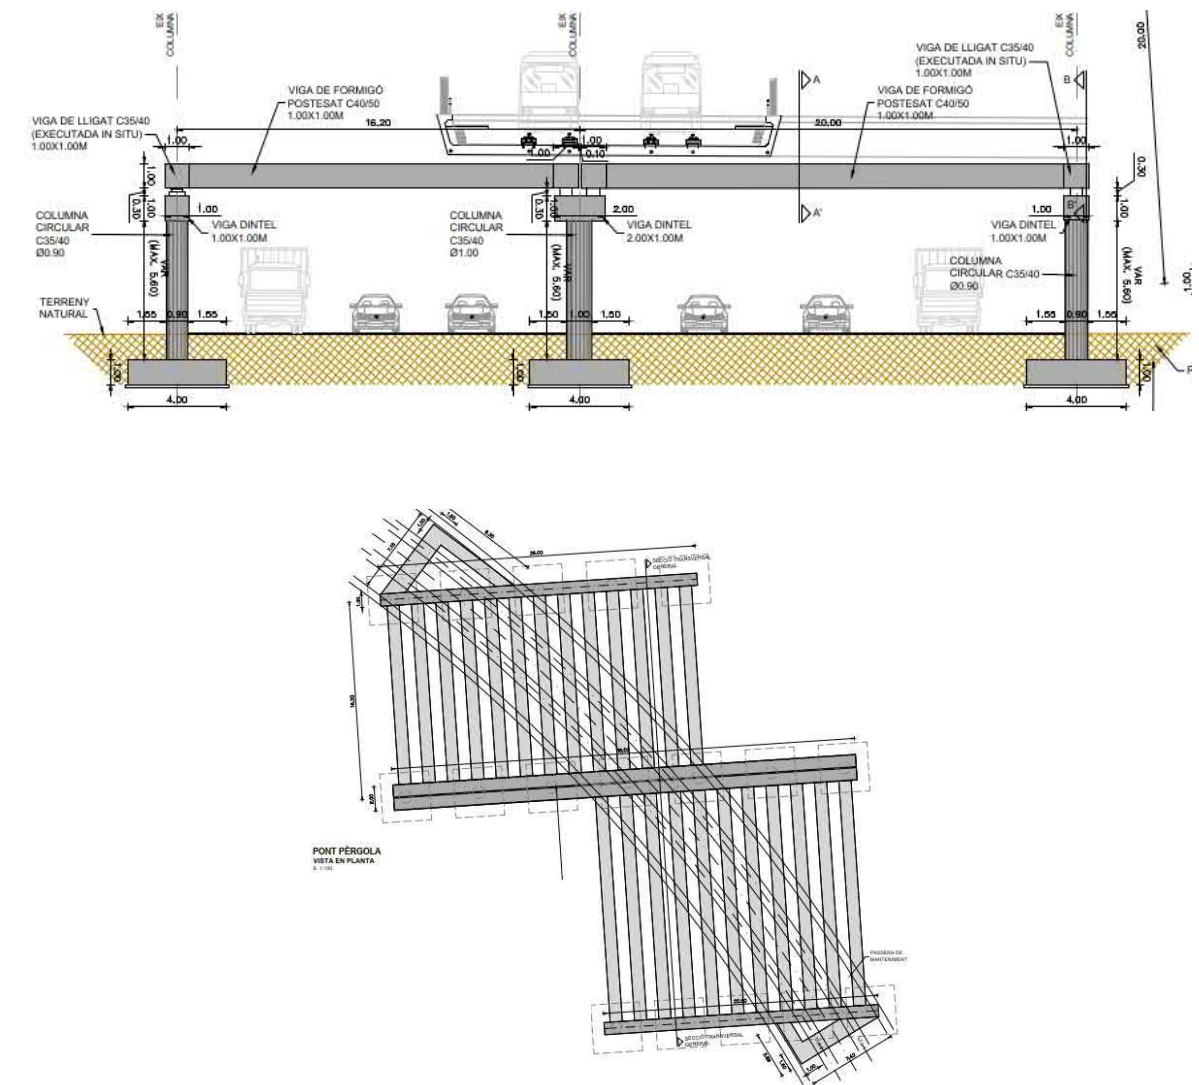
Secció Transversal General i Vista en Planta Pont Pèrgola. Viaducte 1.
